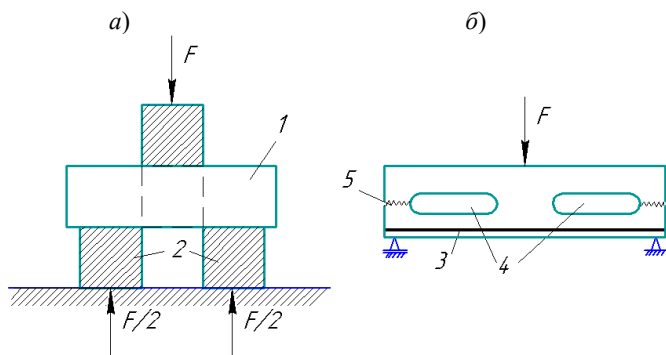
Схема испытания образцов: *a* – на срез; *б* – на скалывание; 1 – испытуемый образец; 2 – неподвижные стальные опоры; 3 – рабочая арматура; 4 – прорезы (щели); 5 – участок, где происходит скалывание бетона
